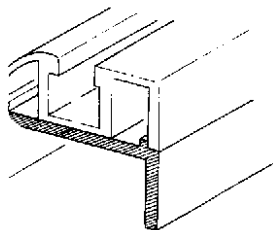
Установка складывающейся двери из двух полотен (Proctor Products)
